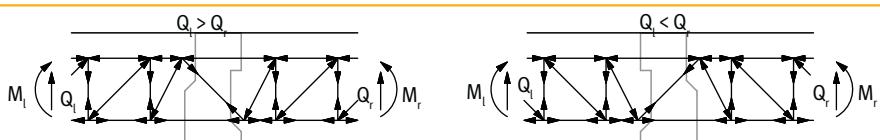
Listverkstruktur for Schöck Isokorb® type K
